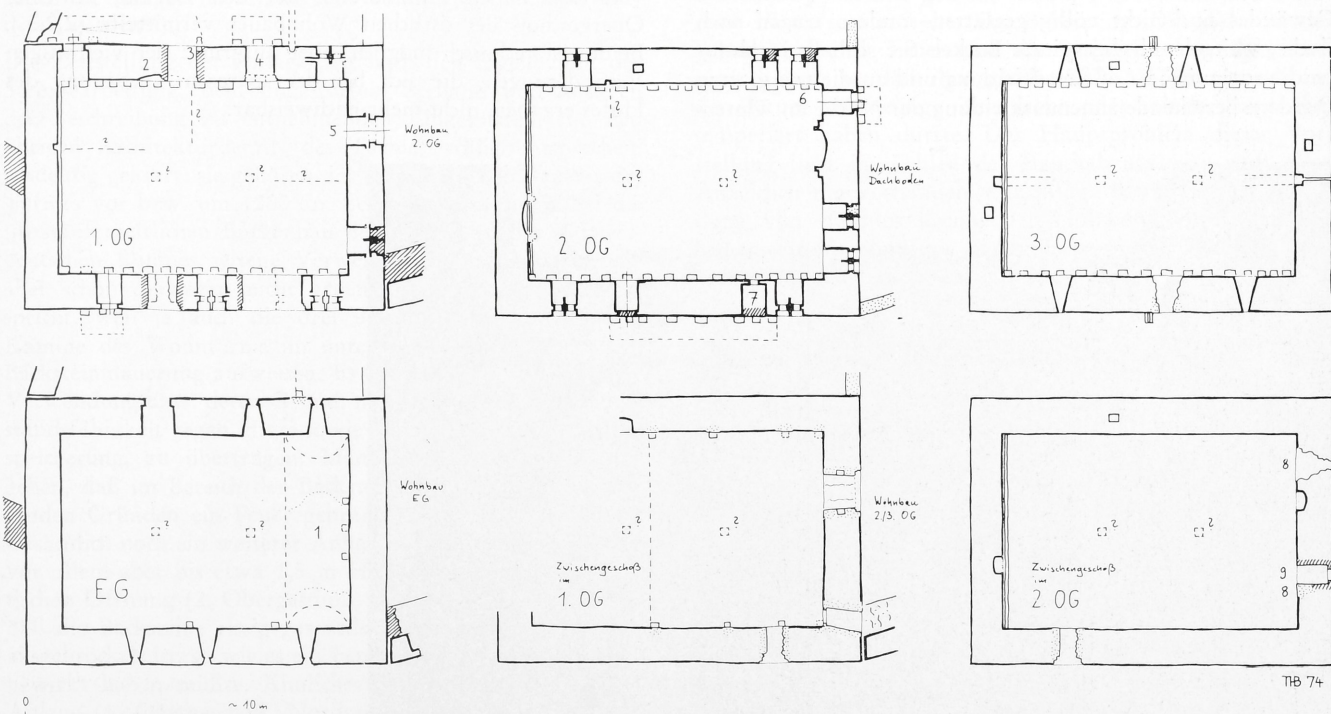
Rathsambausen, Grundrisse des Wohnturms
